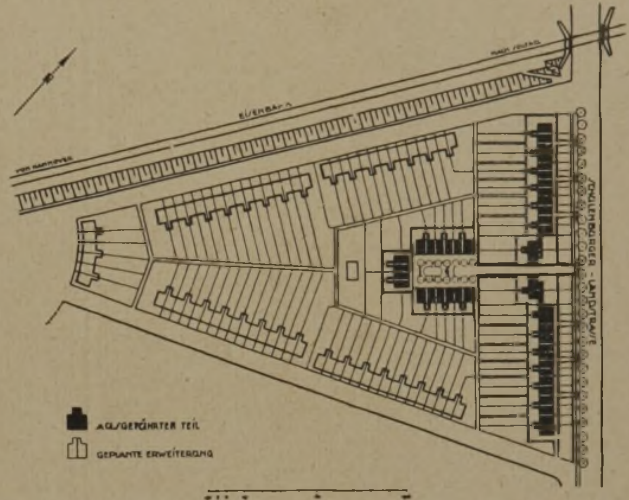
Lageplan. Maßstab rd. 1:4000.
